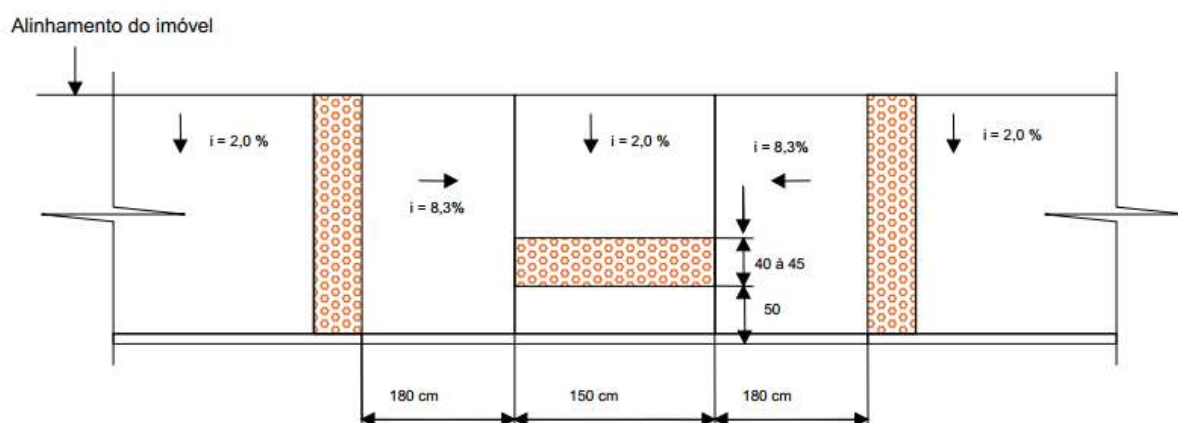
Rebaixo para acessibilidade Tipo 2.
